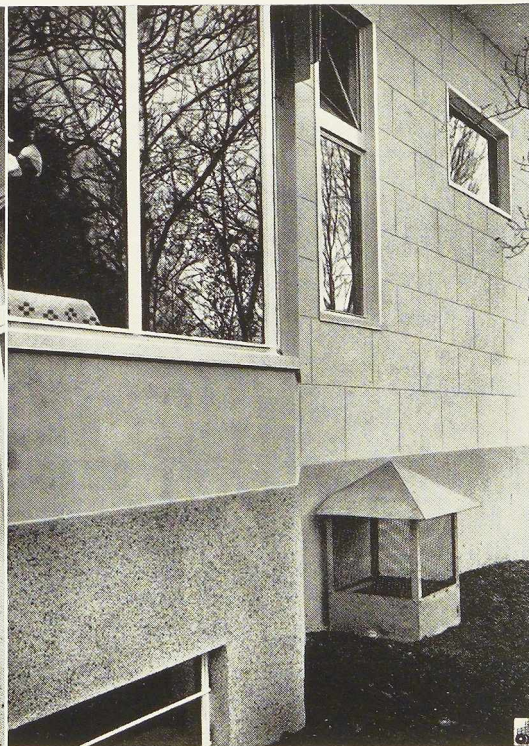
Un détail des façades montrant les enduits en silex concassé. On note la prise d'air frais du conditionnement d'air.
